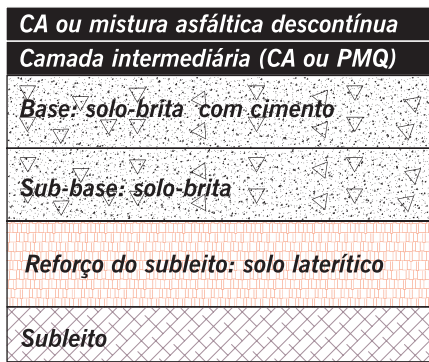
Estruturas típicas de pavimentos asfálticos
